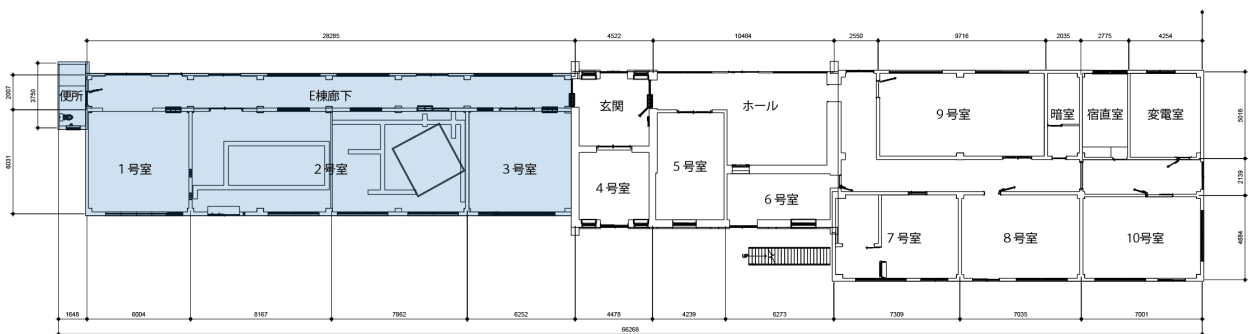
旧理化学研究所板橋分所 E 棟 : 平面図
